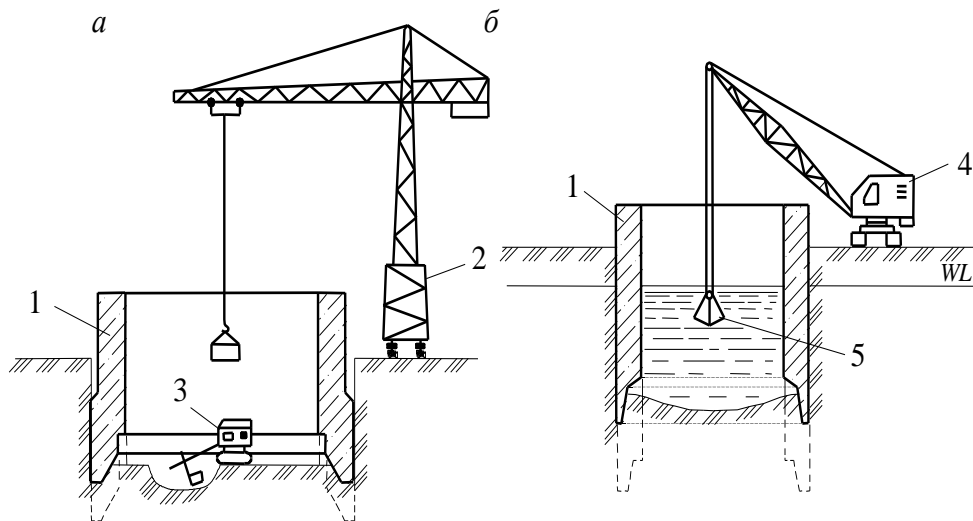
Розроблення ґрунту в опускному колодязі: а – насухо за допомогою екскаватора; б – під водою з допомогою грейфера; 1 – колодязь; 2 – баштовий кран; 3 – екскаватор; 4 – кран-екскаватор; 5 – грейфер
